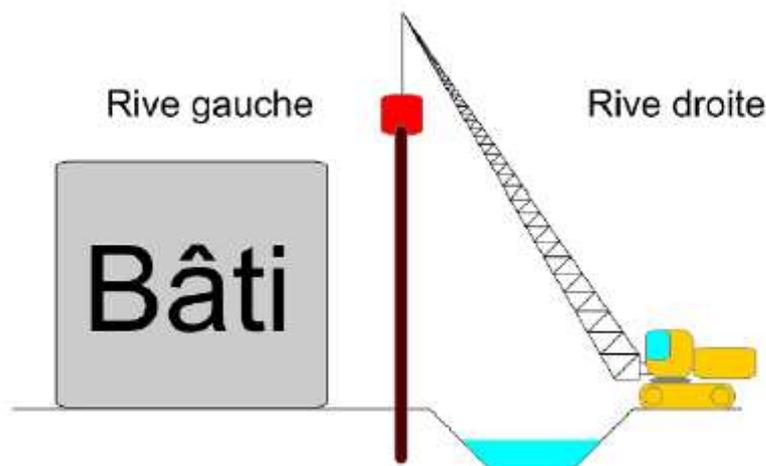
Plan d'accès au chantier (Etude phase PROJET – EGIS Eau septembre 2013)
